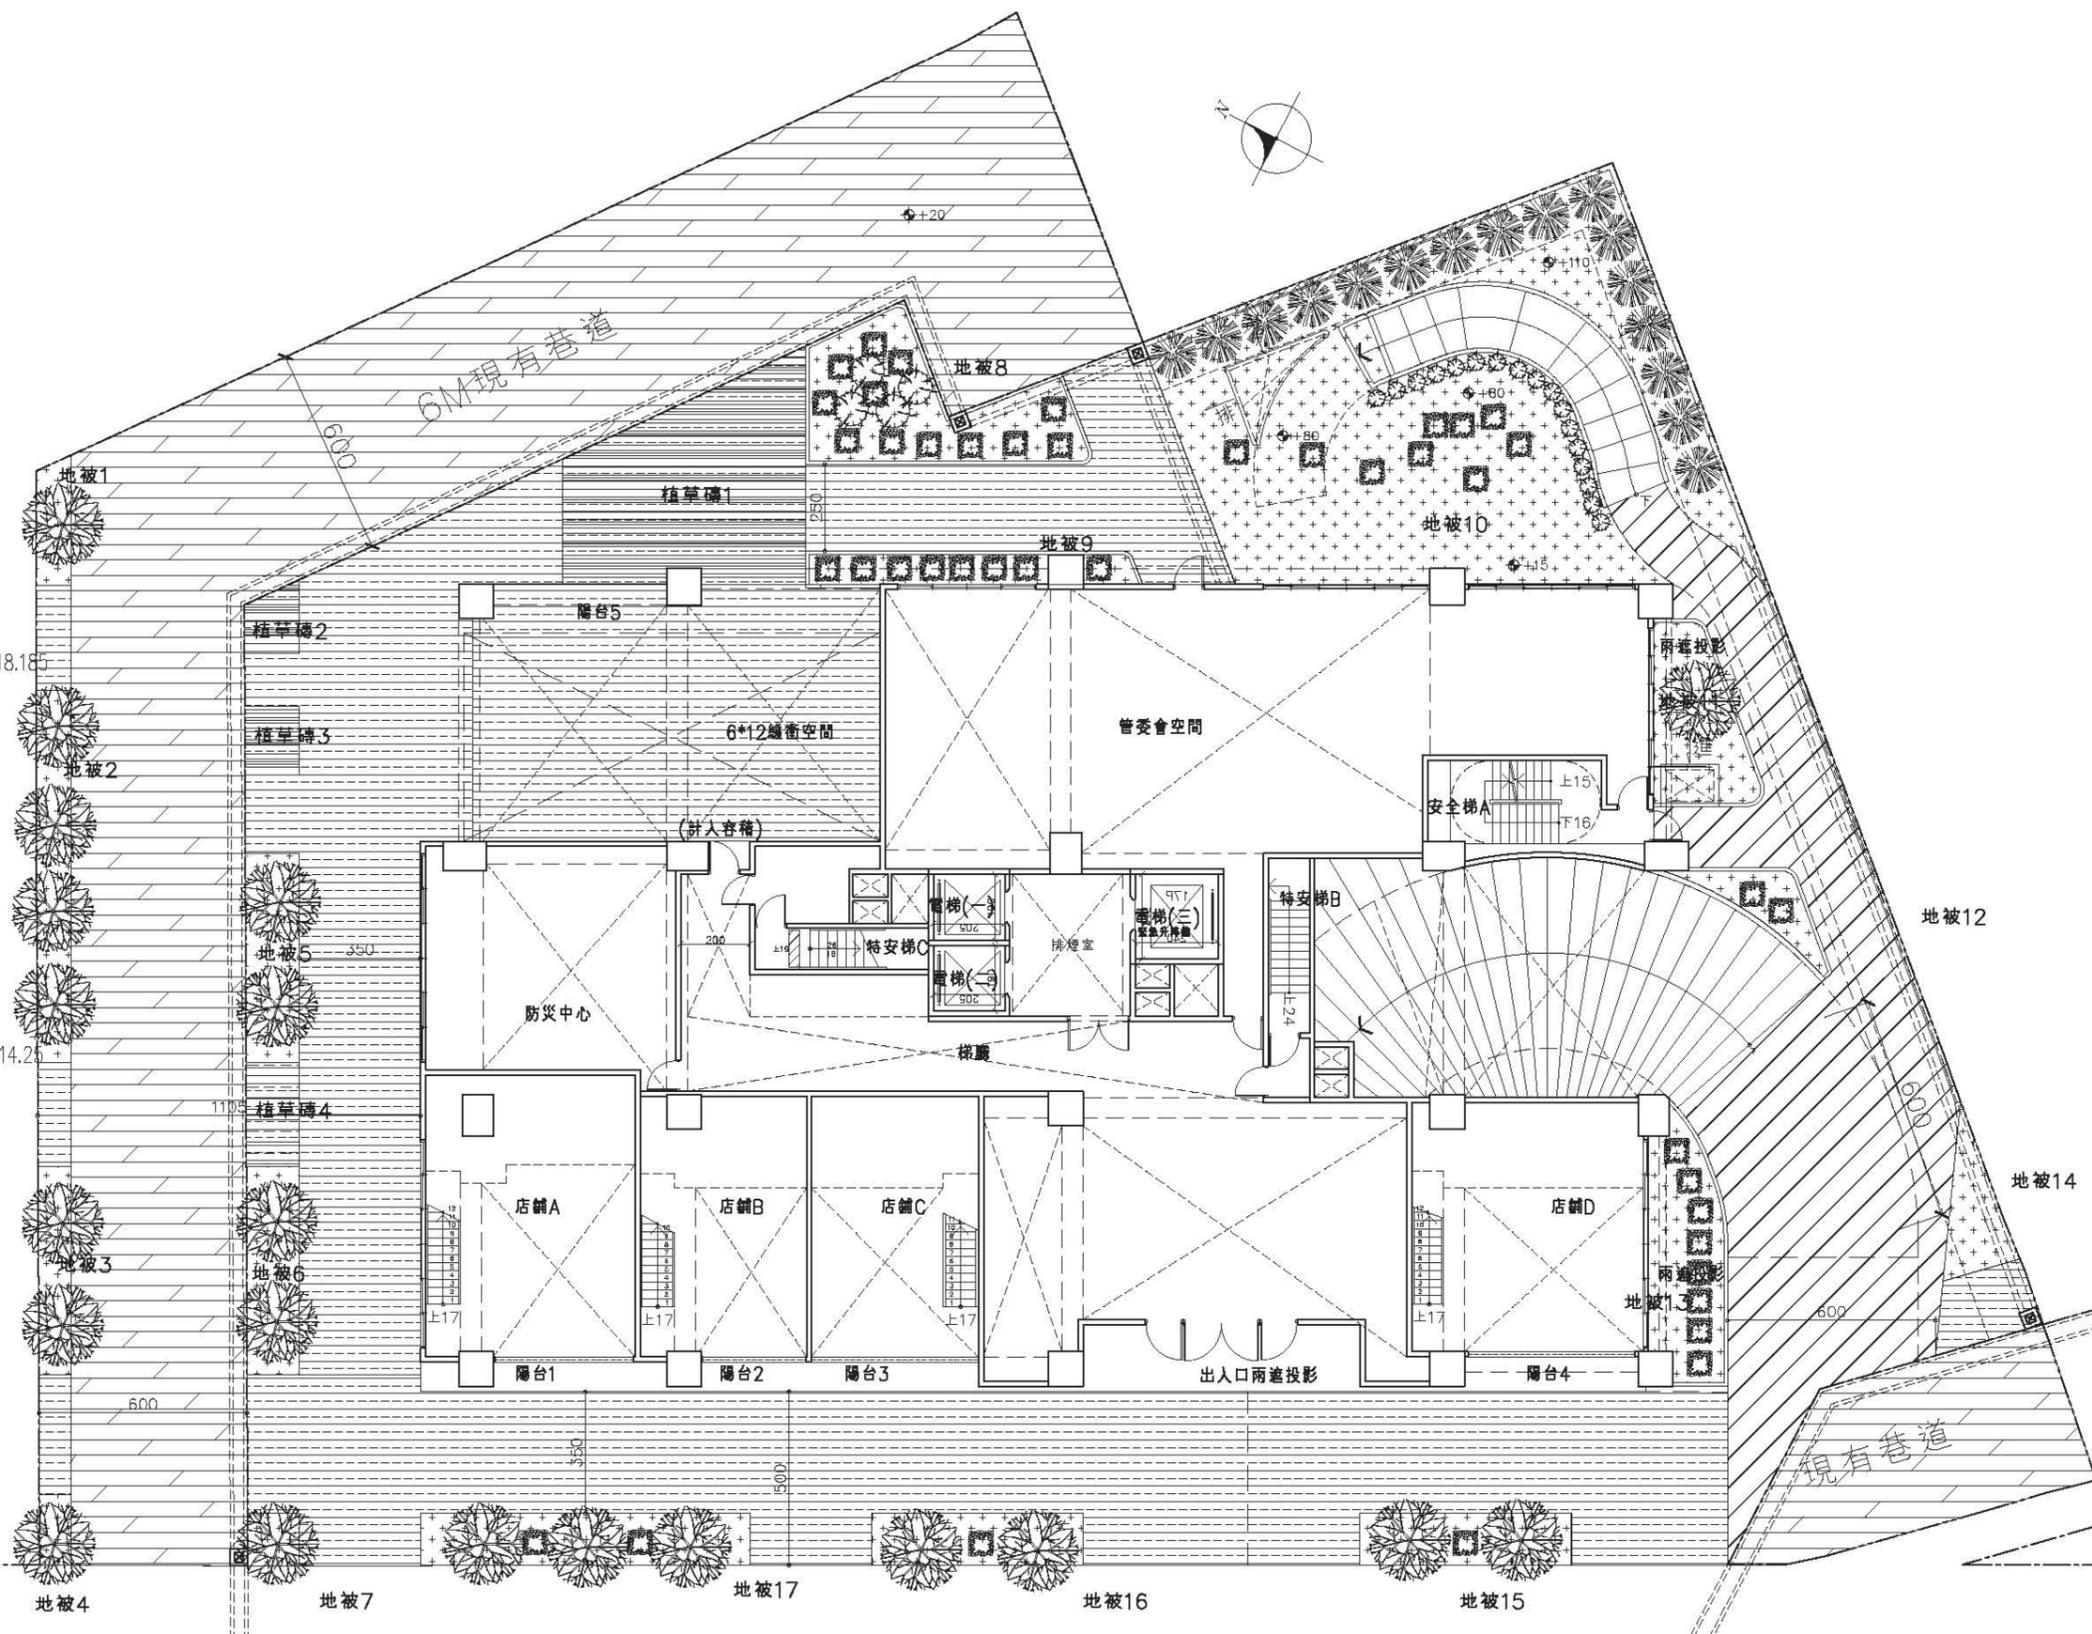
景觀配置平面圖、綠化植栽表、檢討表 S：1/200
